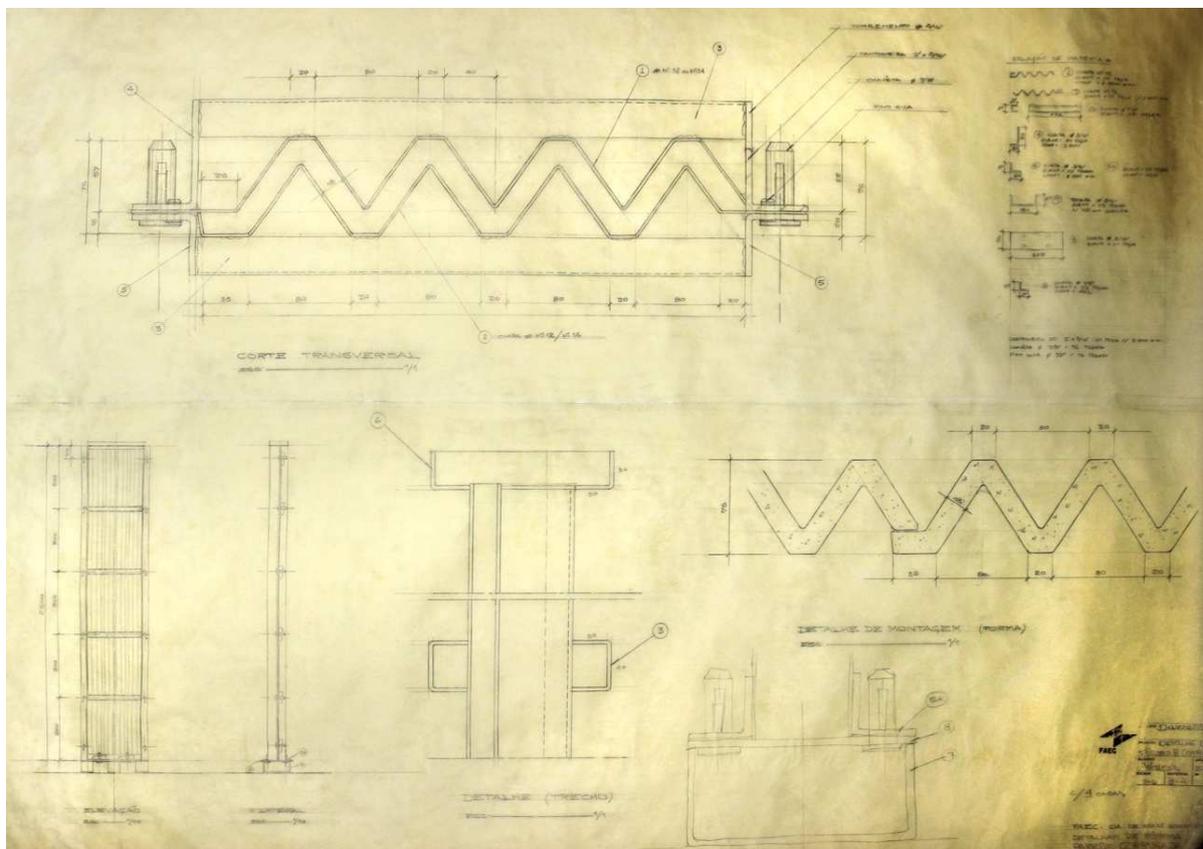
Planta do detalhamento da fôrma da placa plissada de quatro ondas.
